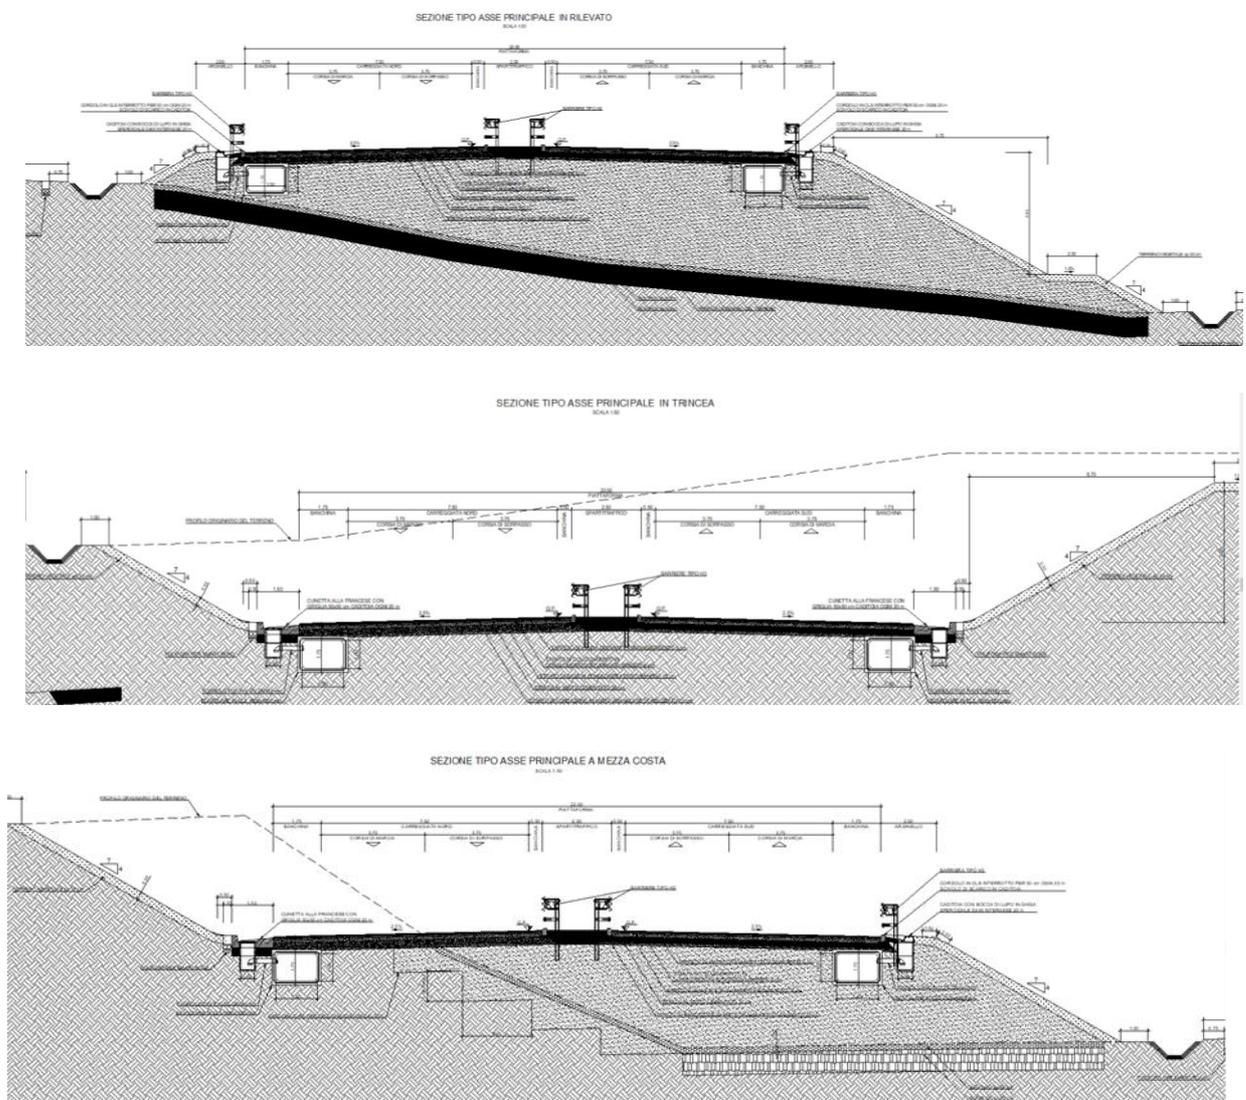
Sezioni tipo asse principale secondo le tipologie dalla sezione stradale in alto verso il basso: sezione tipo asse principale in rilevato, sezione tipo asse principale in trincea, sezione tipo asse principale a mezza costa.
